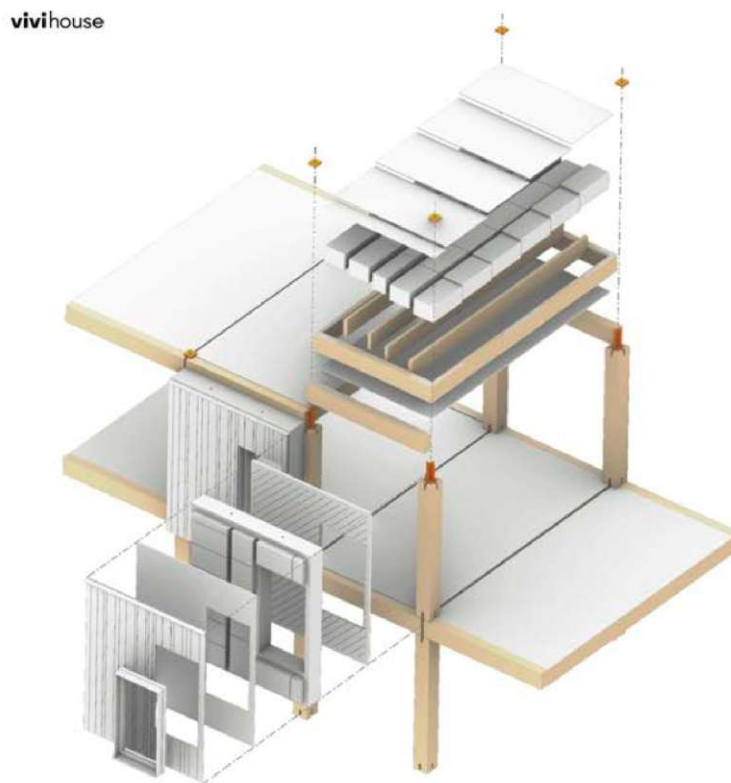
Systemaufbau vivihouse; Quelle: vivihouse.cc
